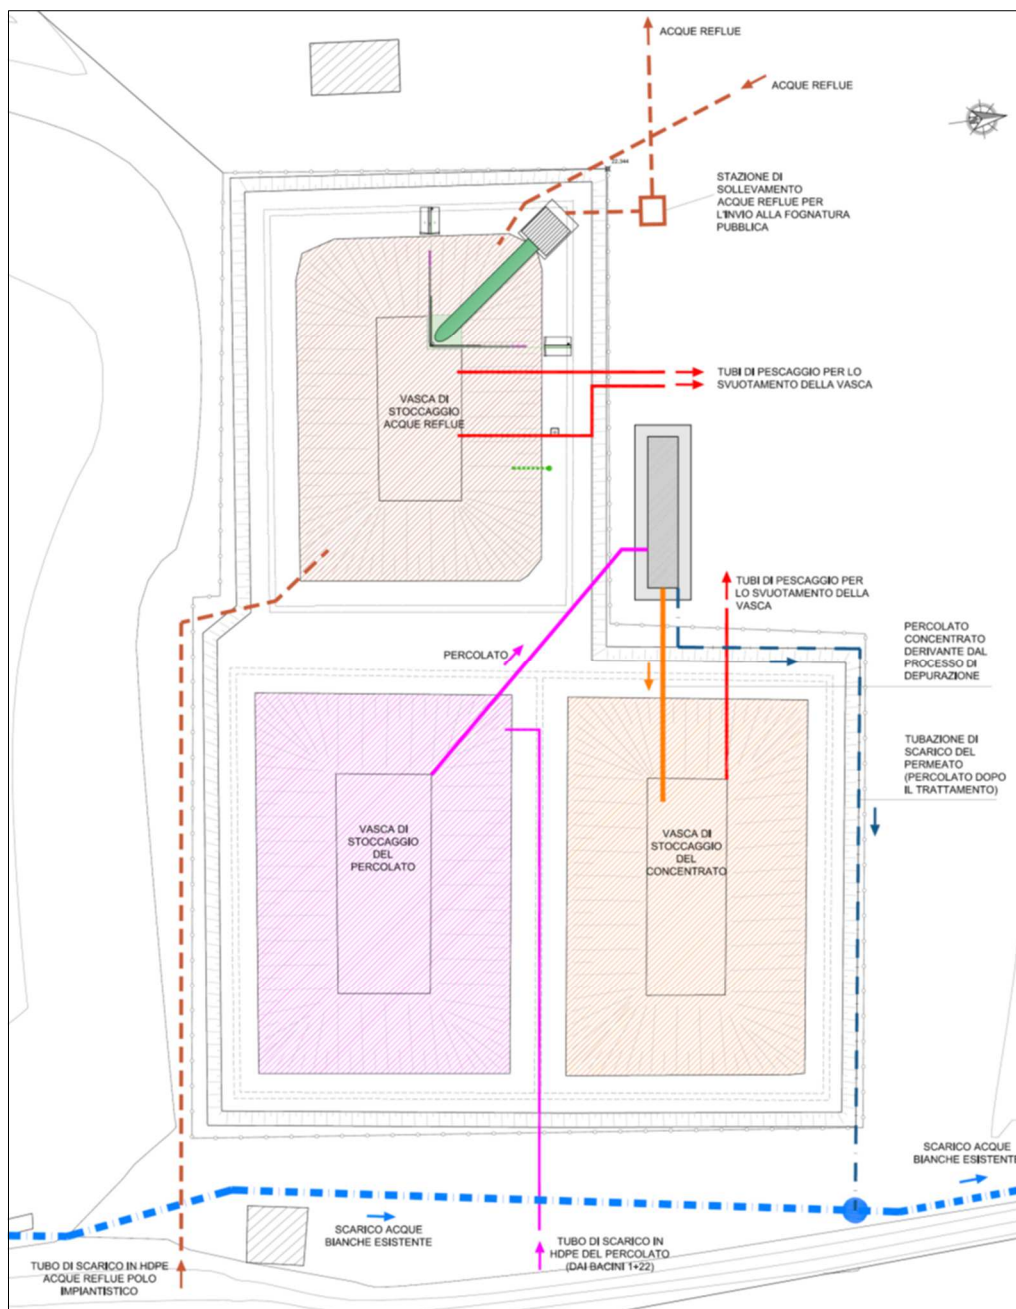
planimetria di dettaglio del sistema di alimentazione e scarico
